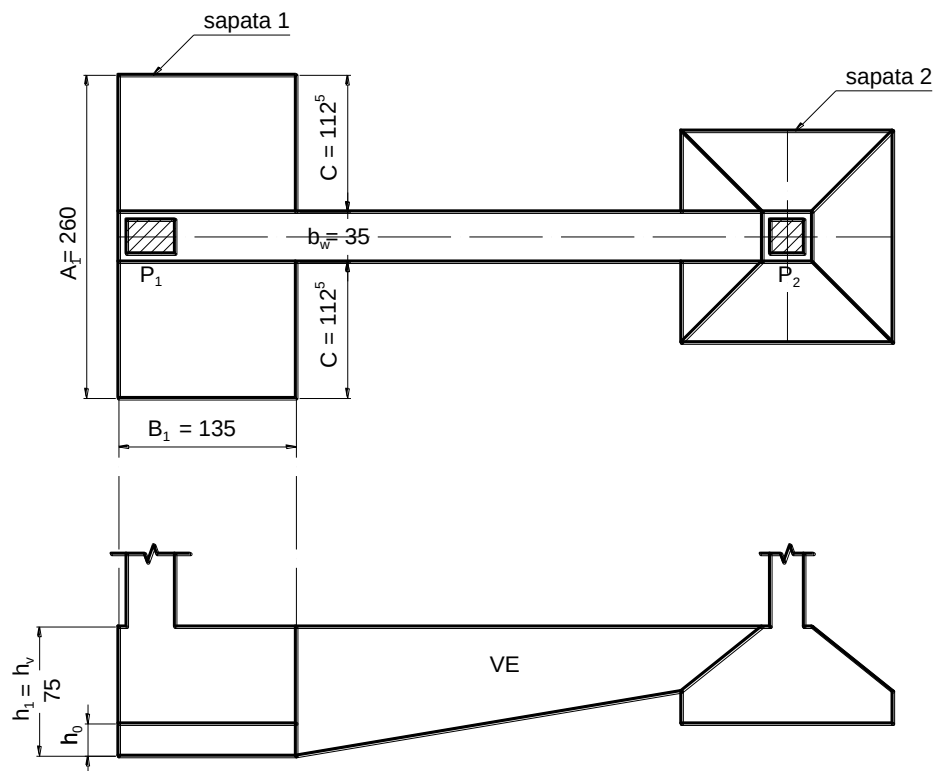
Dimensões (cm) da sapata sob o pilar de divisa.
